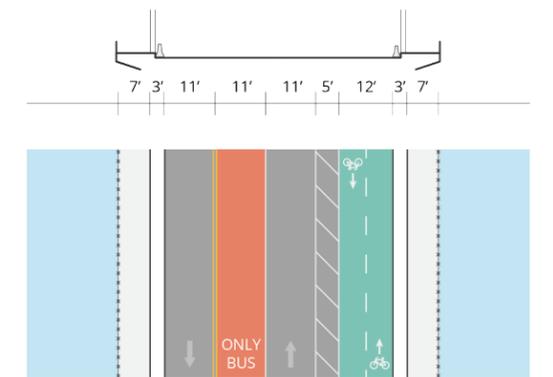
FIG XX - PUENTE DE LA CHELSEA STREET - CONDICIÓN PROPUESTA
